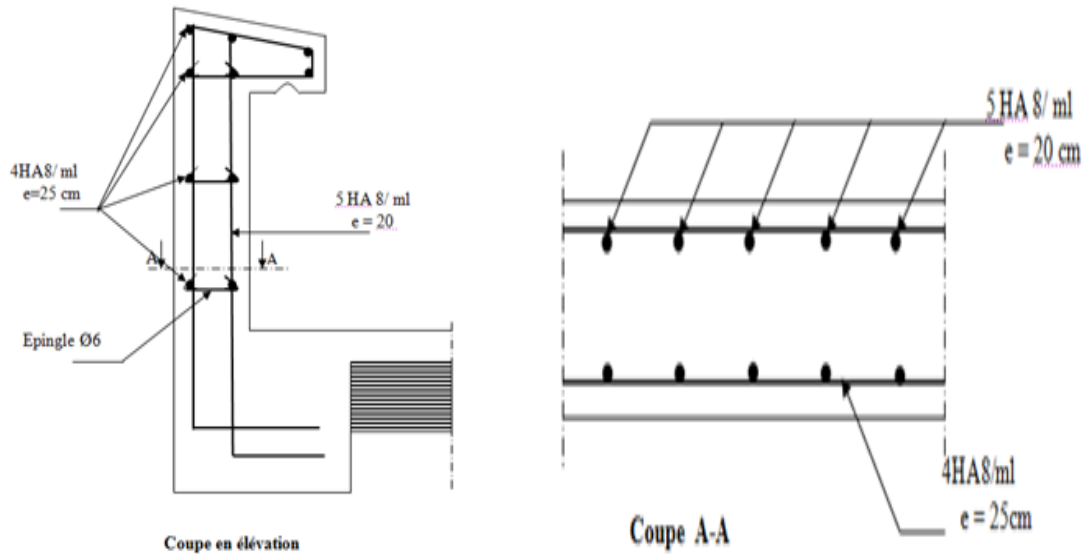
Ferrailage de l’acrotère du plancher terrasse.
